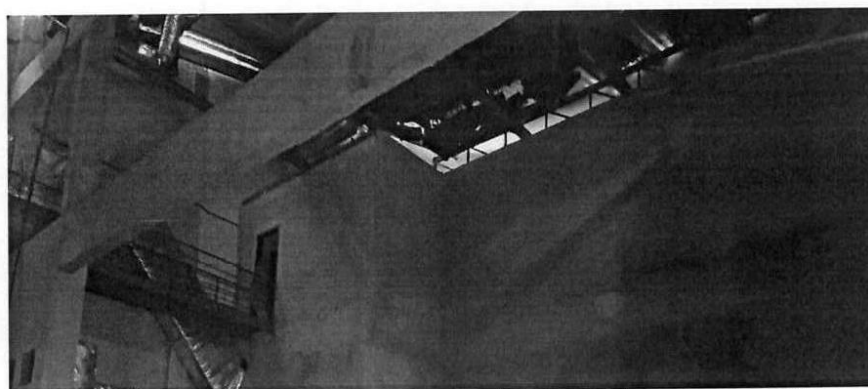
Estrutura metálica – necessita tratamento contra corrosão
